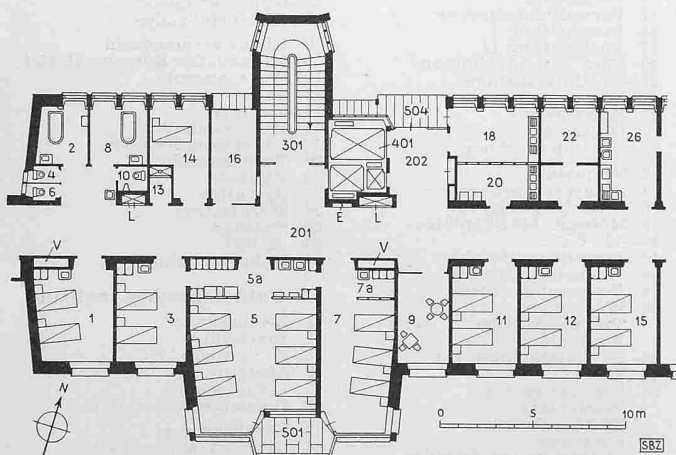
Typischer Grundriss einer Pflegeeinheit im Bettenhaus West, Masstab 1:400
